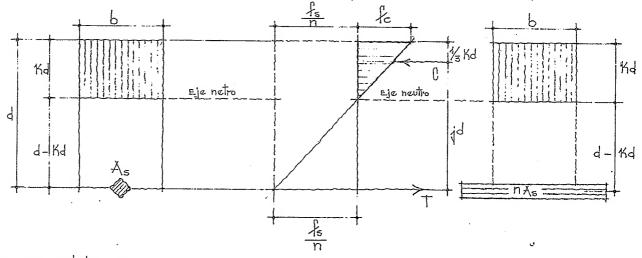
Corte transver sal de la viga. Fig. 3.7. Deformación de la viga. Esfuerzos. Fig. 3.8. Area trans formodo.
